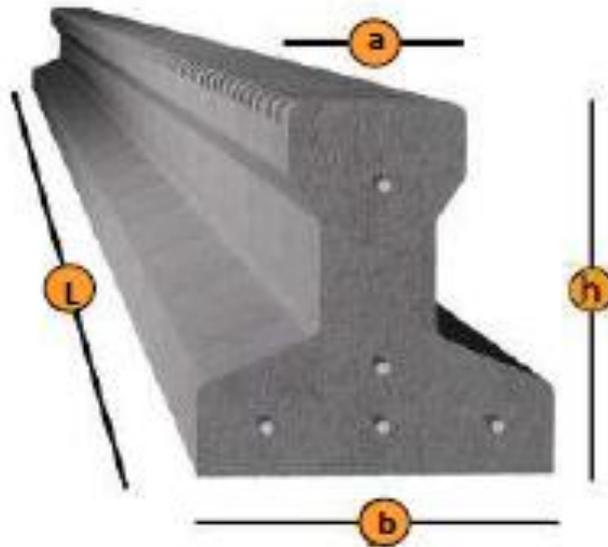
dimensiones de una vigueta pretensada por CONCRETEC
